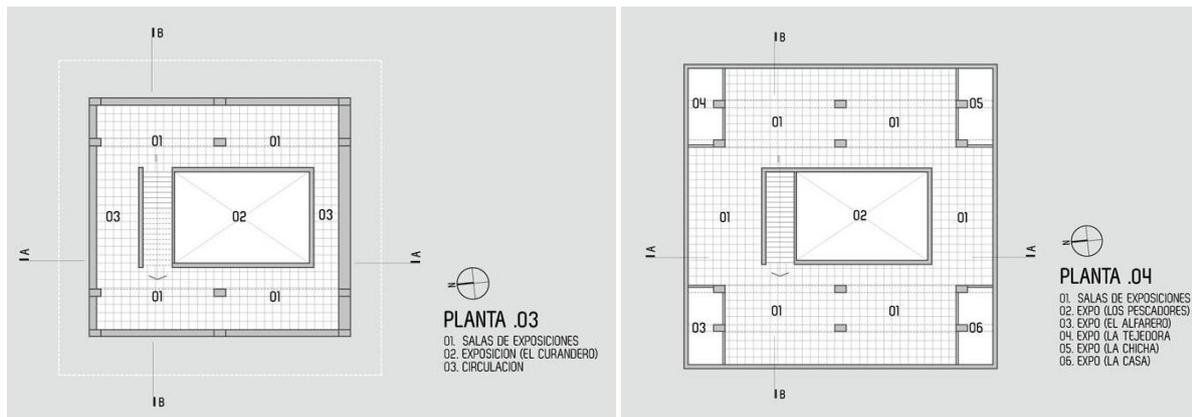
Planta del tercer y cuarto nivel. Fuente: Archdaily, 2010. Elaboración: Imagen de Porta Guerrero, Paul (2010). Blog de Arquitectura Moderna.
